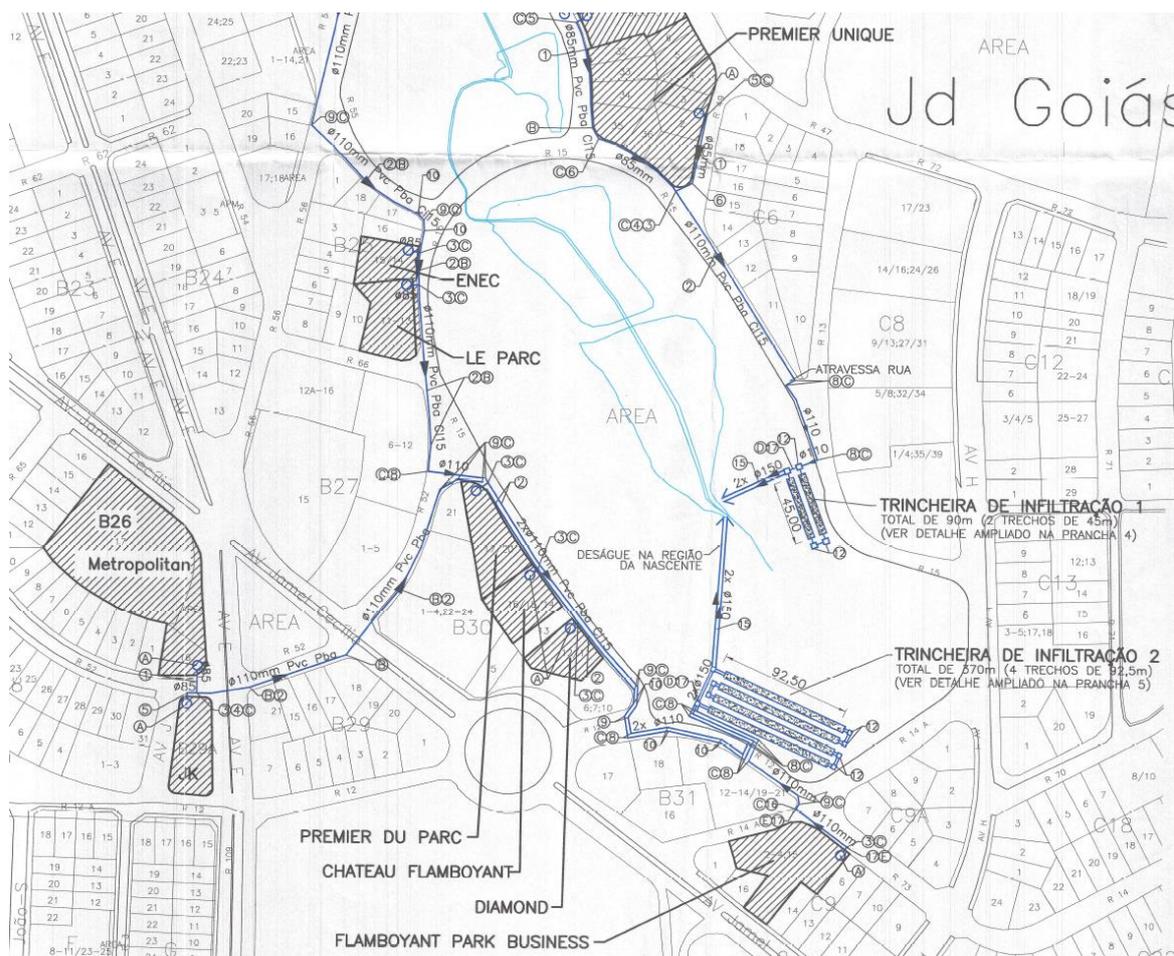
Trecho da planta de localização das trincheiras de infiltração no Parque Flamboyant.
